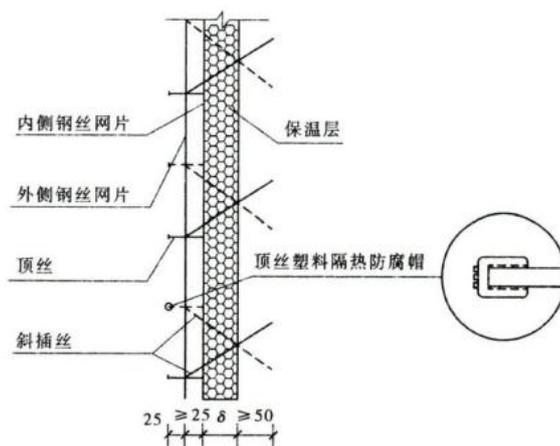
焊接钢丝网架保温板构造示意图（单位：mm）
